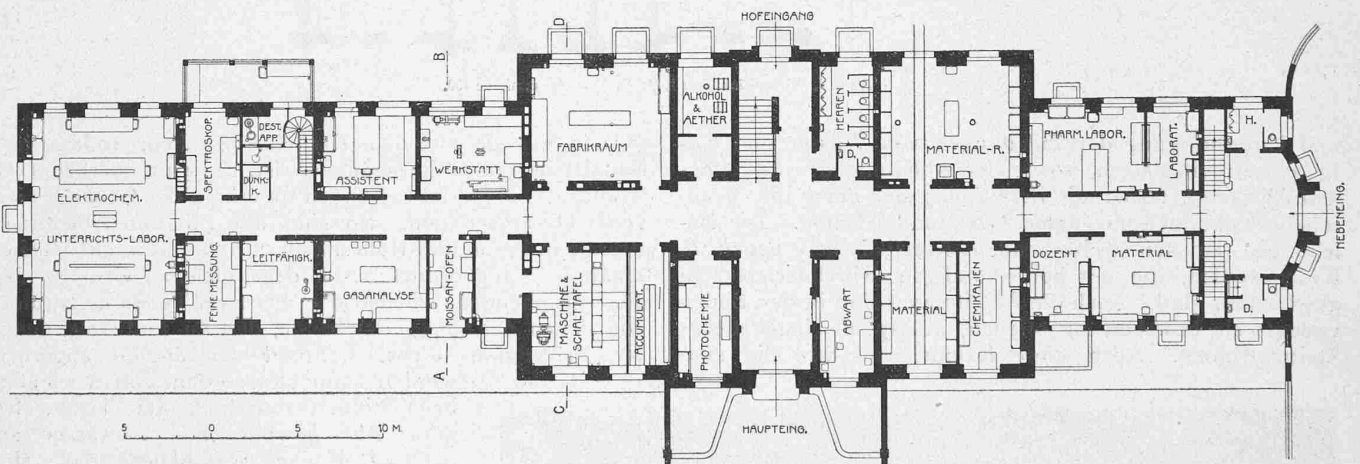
Erdgeschoss-Grundriss. — Masstab 1:400.
